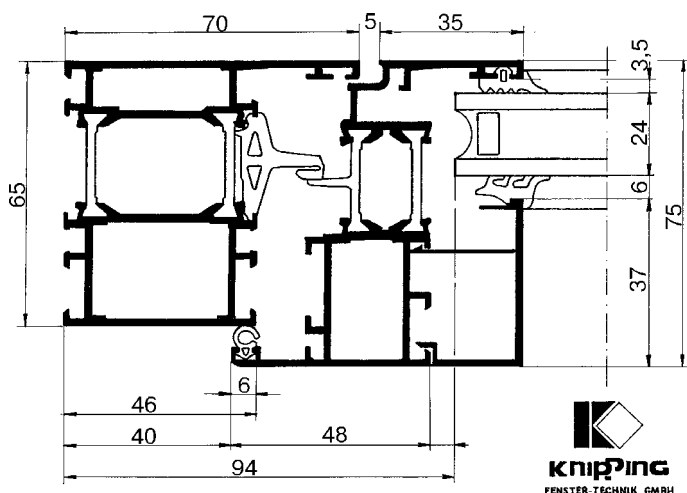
Алюминиевый профиль фирмы “KNIPPING”
